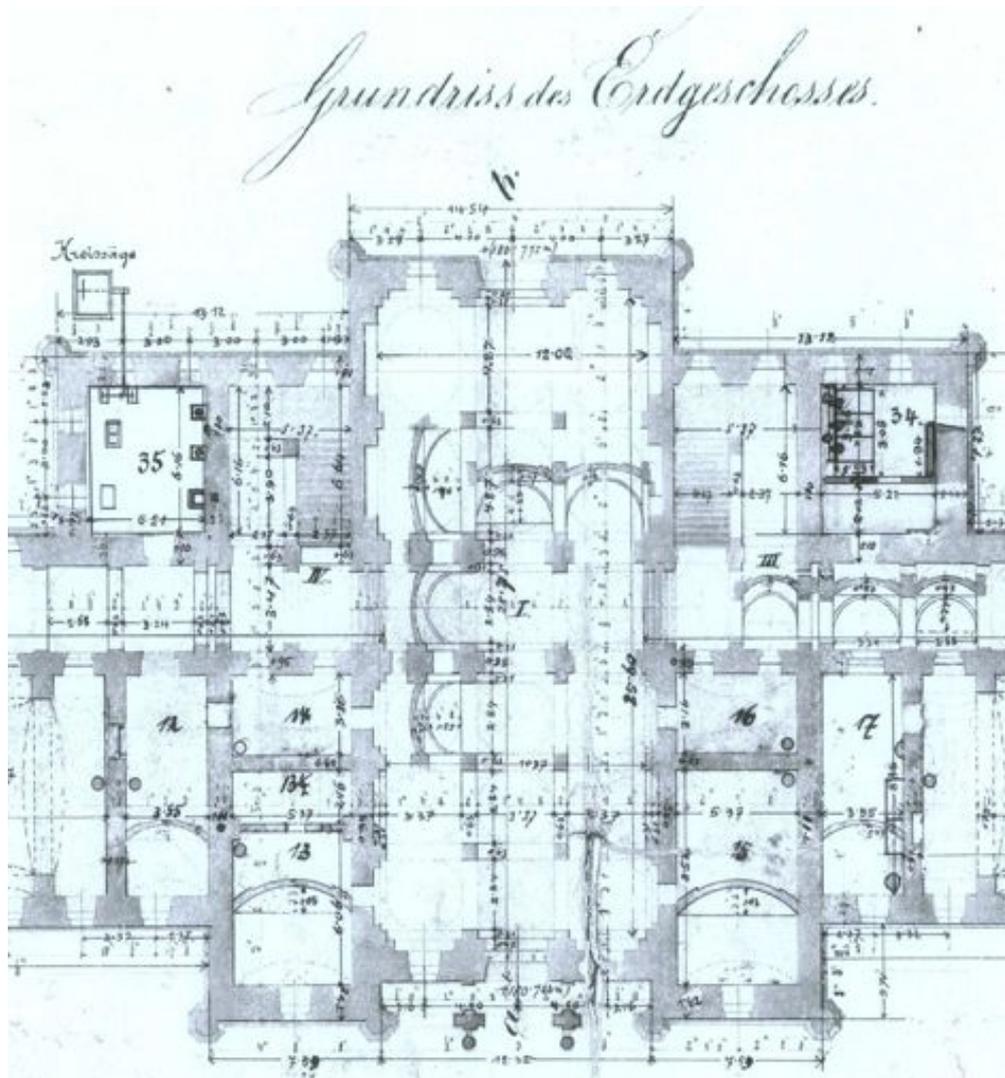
k. k. Kadetteninstitut, Grundriss,
